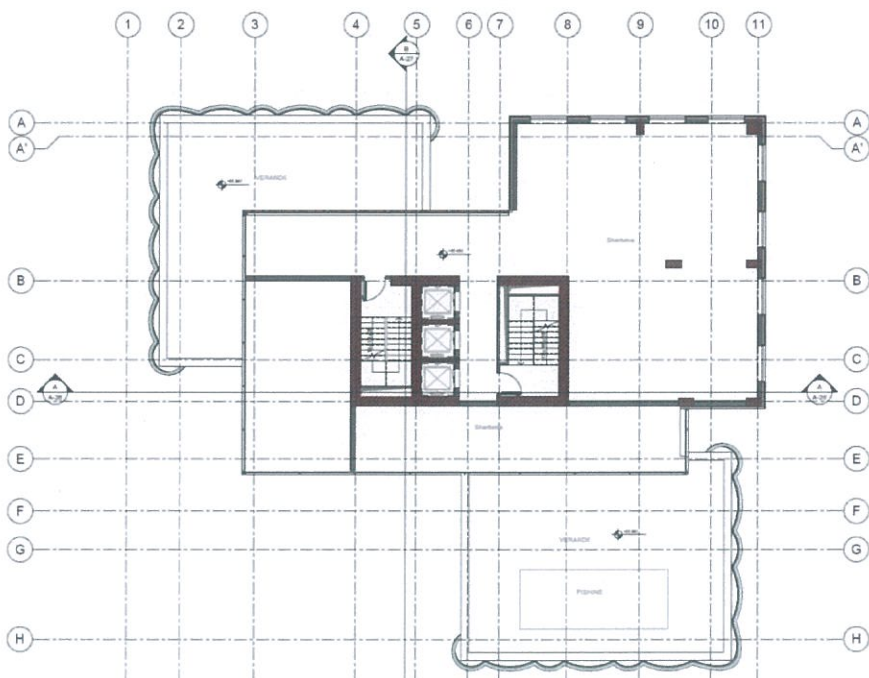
Plani i Katit +18 - Hotel, Kuota +65.88
